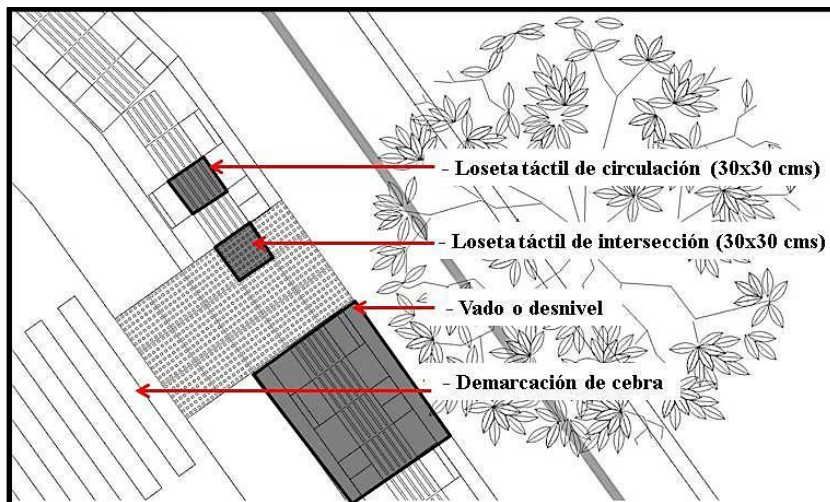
Ejemplo en planta de disposición de vados y losa táctil (Fuente: elaboración propia, 2018)
